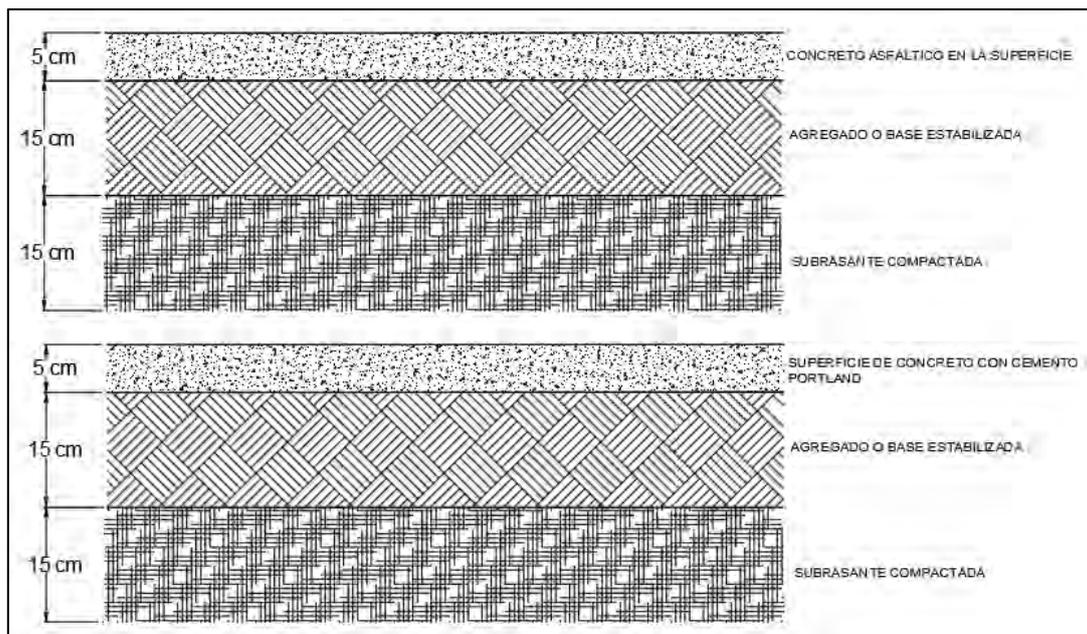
Detalle de Pavimento rígido y flexible para la ciclovía
